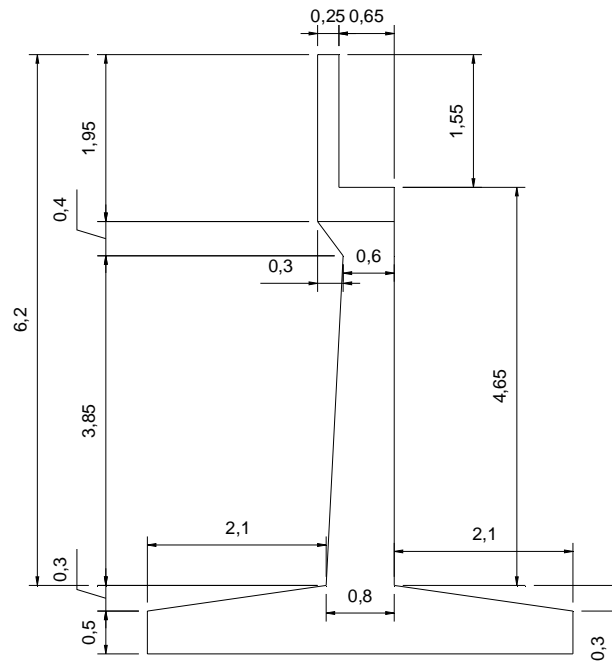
Dimensiones del Estribo.
